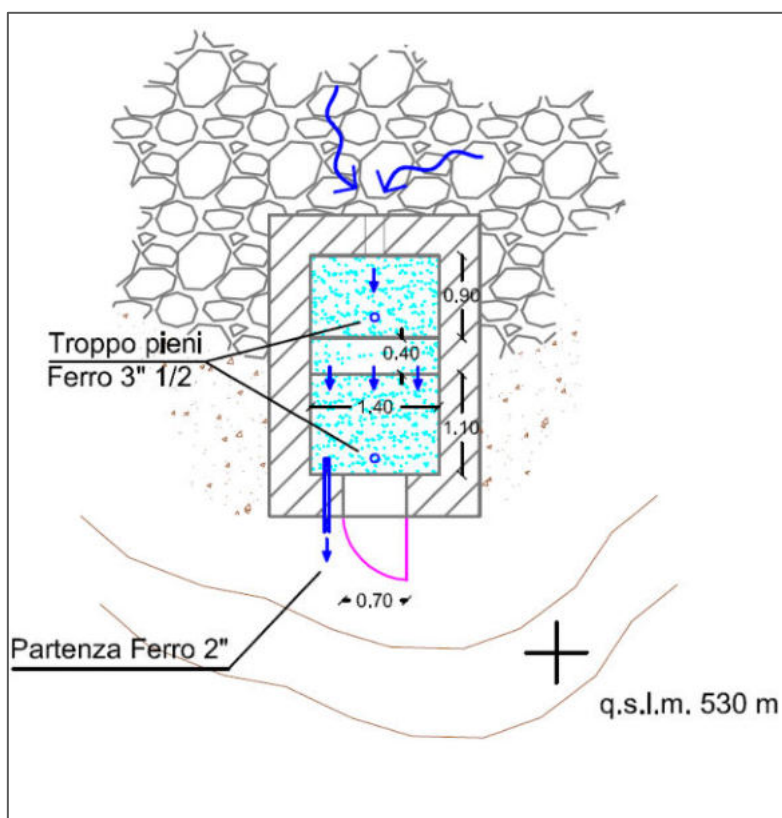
Pianta e Prospetto frontale Sorgente 2 Boscacci
